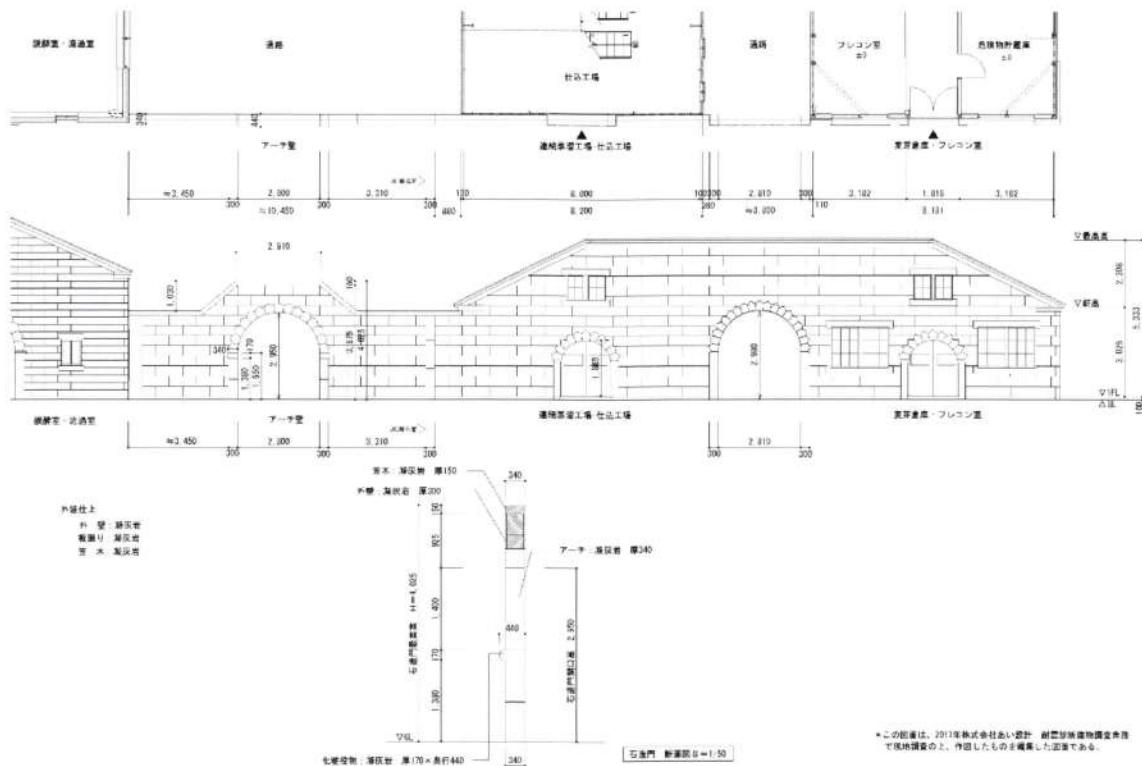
アーチ壁 立面図・平面図 (株式会社シン技術コンサル提供)
